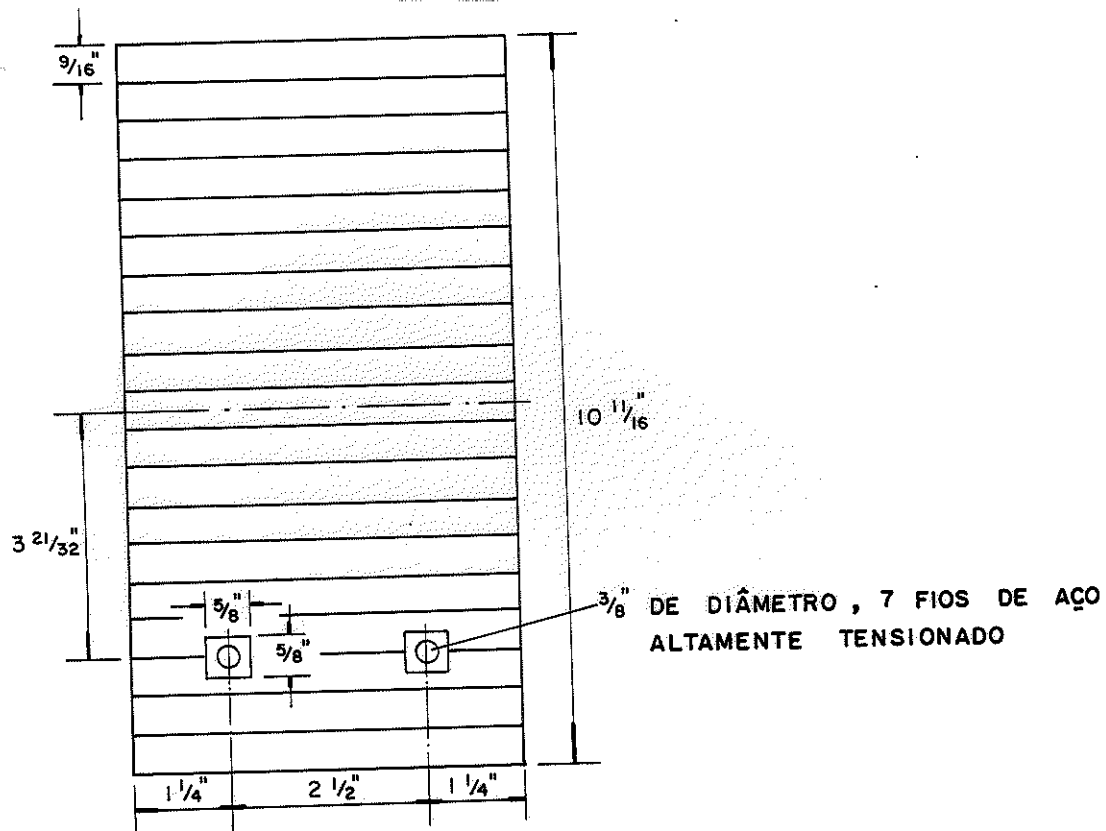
SEÇÃO TRANSVERSAL DA VIGA DE MADEIRA LAMINADA PROTENDIDA - BOHANNAN
